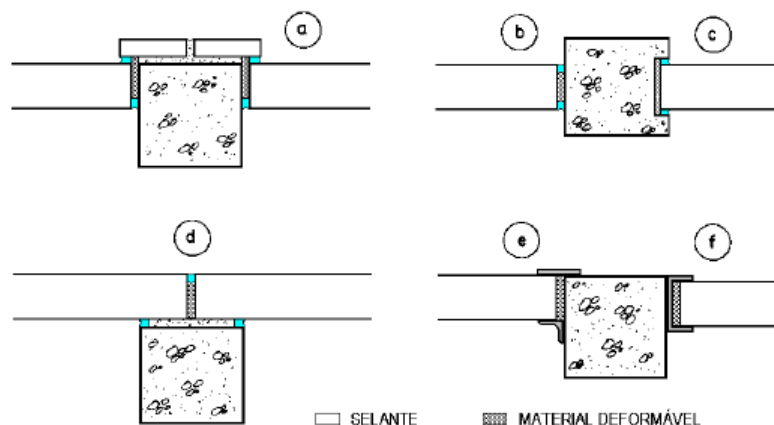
Ligações entre alvenarias e pilares, recomendadas para estruturas flexíveis: (a) pilar revestido com tijolos cerâmicos; (b) junta aparente na borda do pilar; (c) junta encaixada no pilar; (d) junta aparente no corpo do pilar; (e) mata-juntas fixadas nos pilares; (f) cantoneira fixada no pilar (THOMAZ, 2000).
